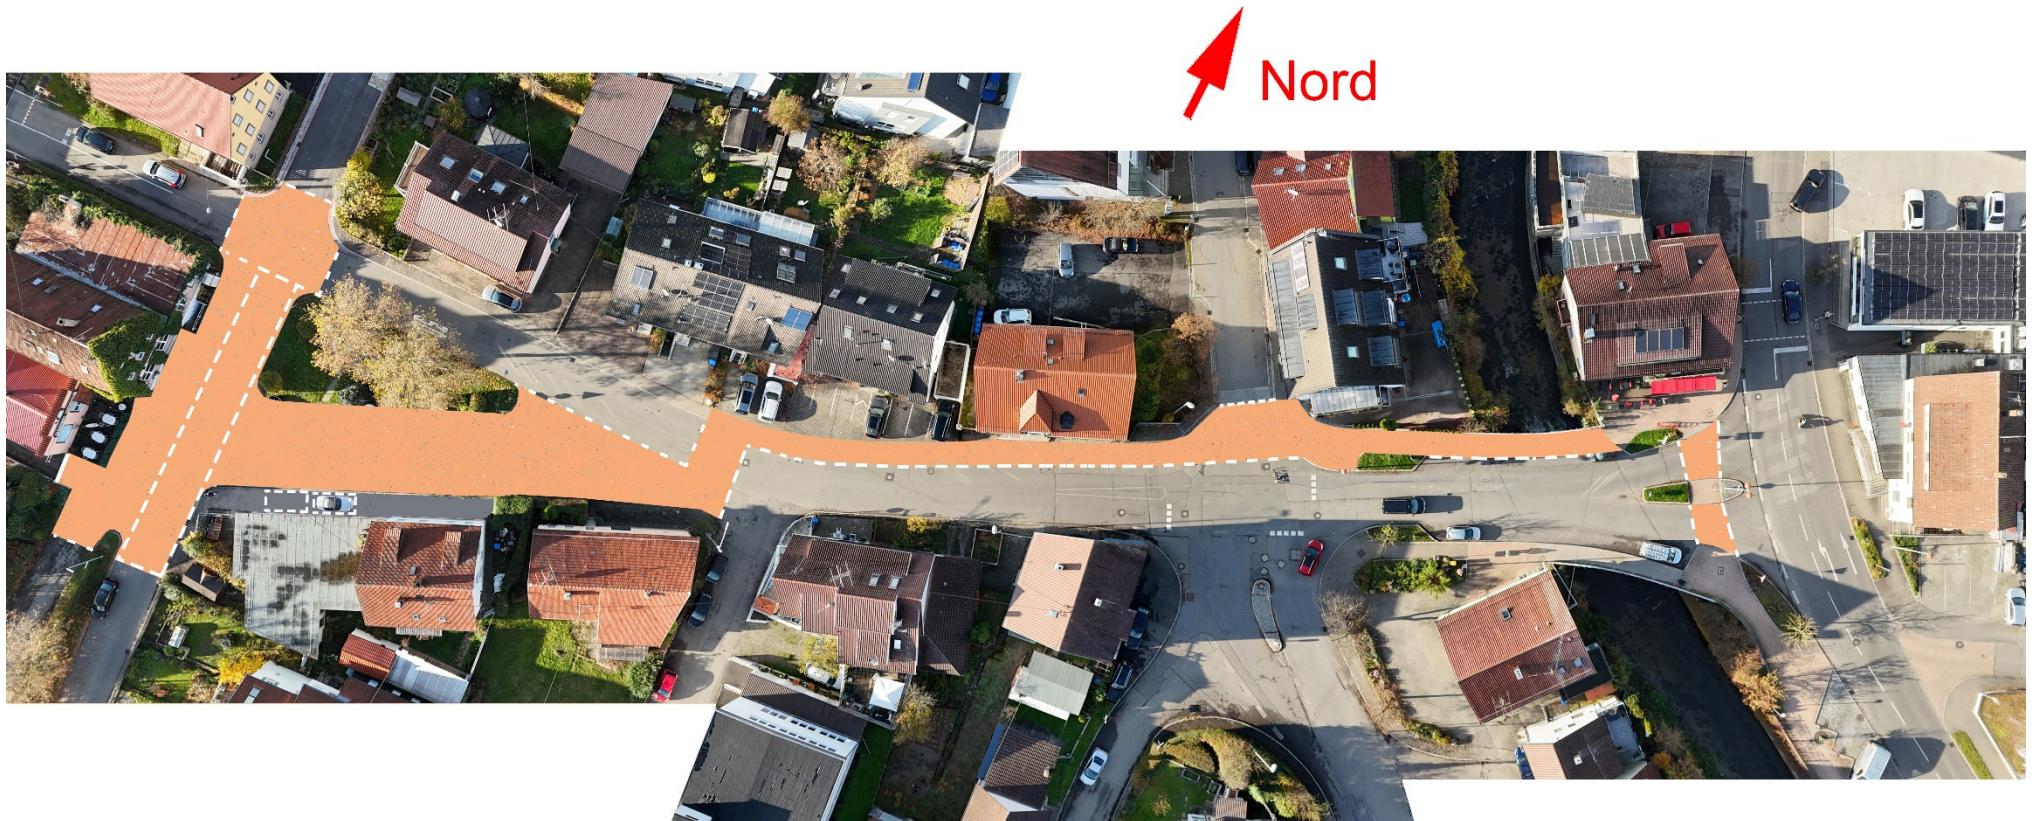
Bahnhofstraße mit Fußgängerflächen
